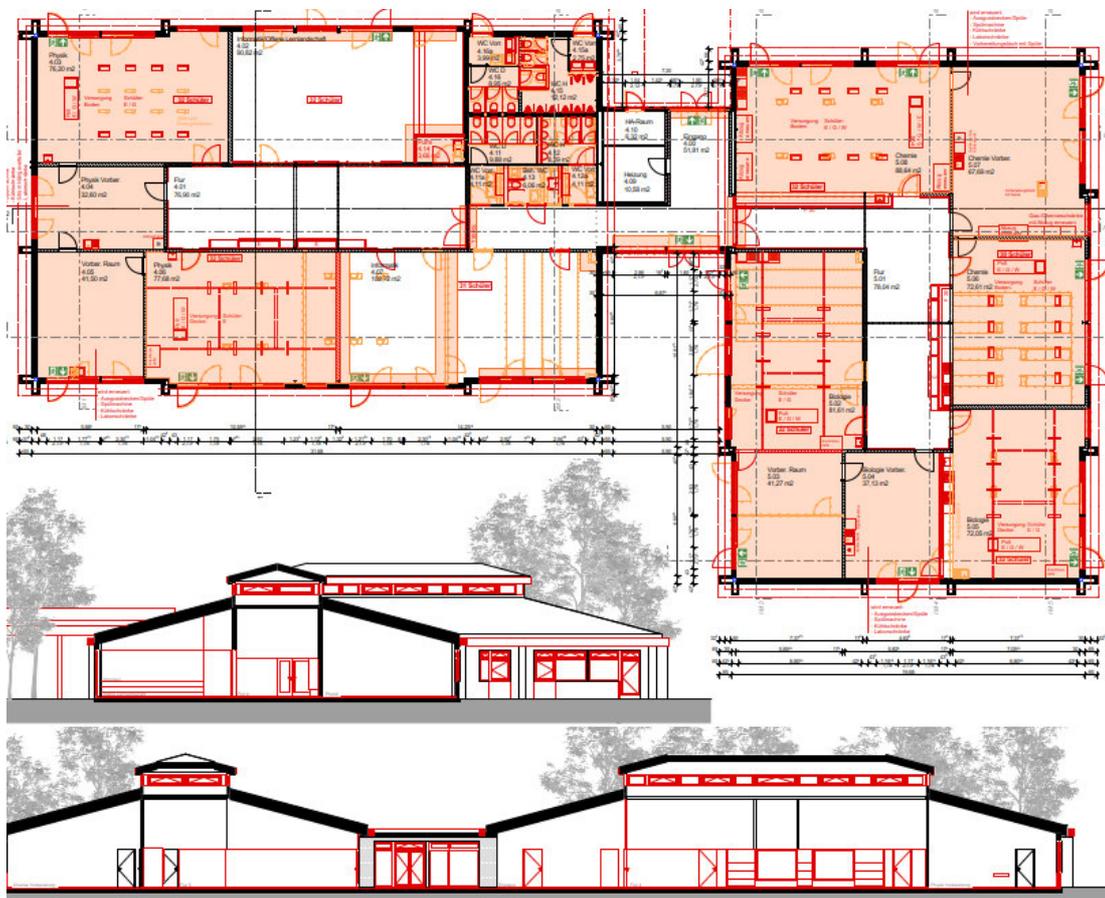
Grundrissausschnitt/ Schnitt
